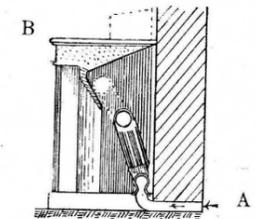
FIG. t. — Sezione trasversale del caminetto d'angolo con circolazione d'aria calda e presa d'aria dall'esterno. A, Presa d'aria fredda dall'esterno. — B, Bocchetta e griglietta d'uscita dell'aria calda.
